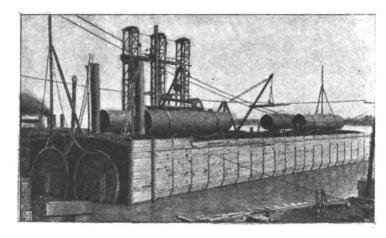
Tunnel sotto il Detroit River - Immersione di un tronco
